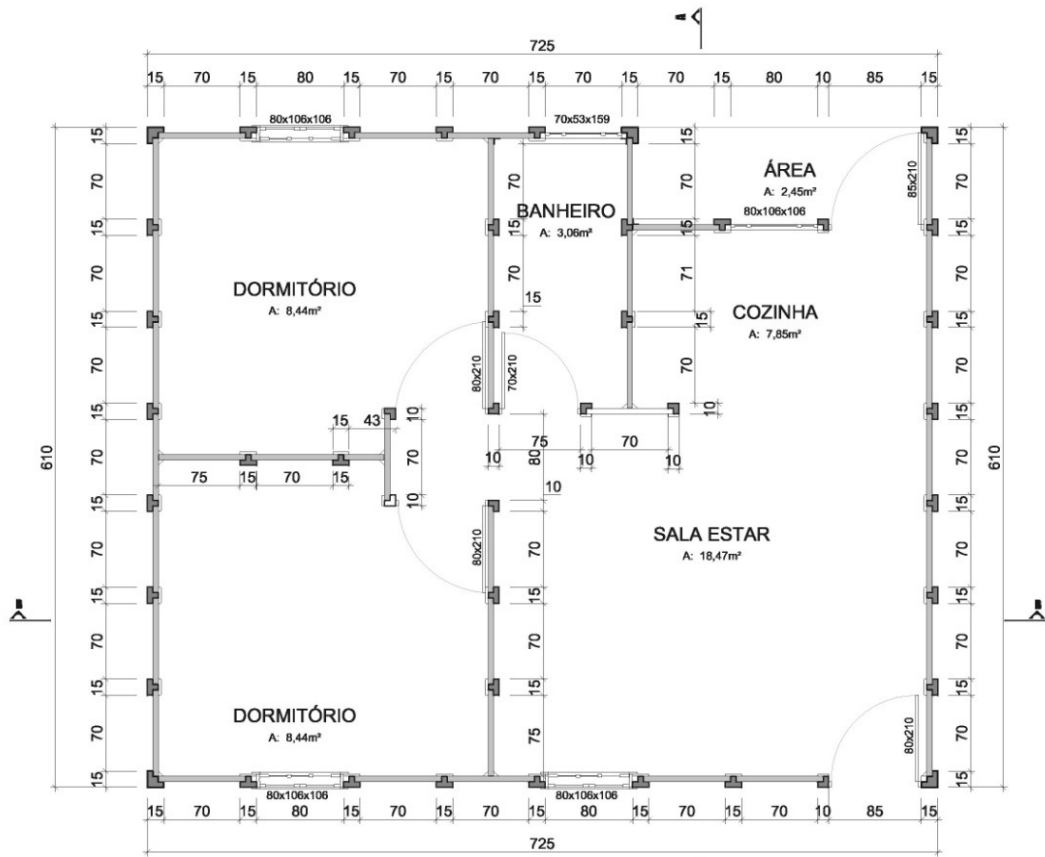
Planta baixa de locação dos pilares do projeto da residência de 44,32m².
